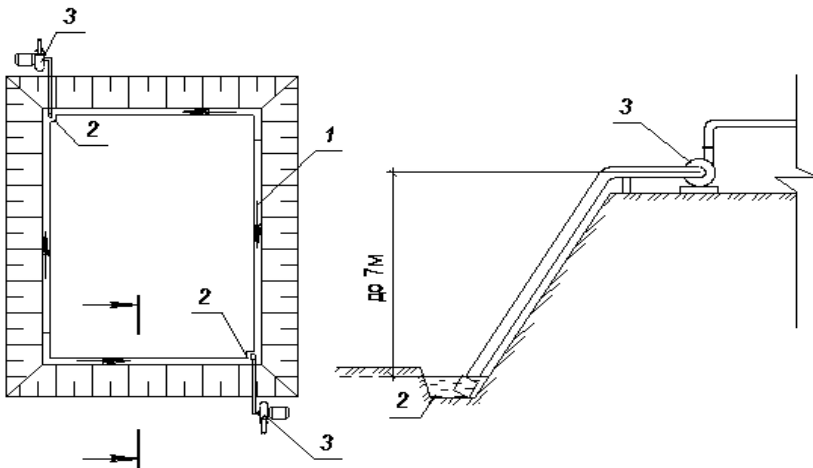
Схема открытого водоотлива с расположением водопонизительной системы в плане:
